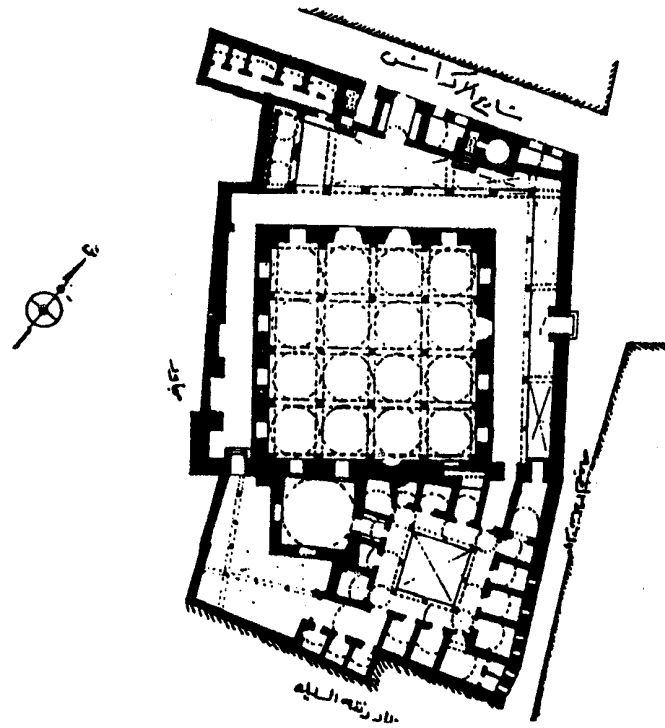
مسقط أفقي لمدرسة وجامع سوکوللو محمد باشا باستانبول
